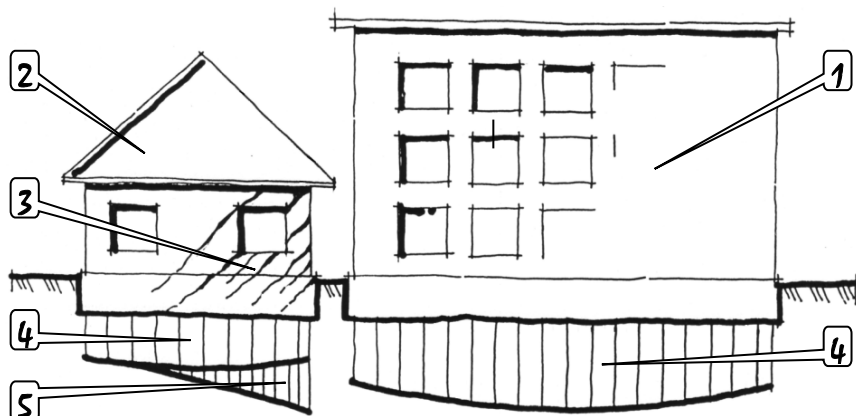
Пошкодження при зведенні нової будівлі біля існуючої: 1 – нова будівля; 2 – існуюча будівля; 3 – зона появи і розвитку тріщин; 4 – епюра осідань фундаментів; 5 – епюра додаткових осідань фундаментів
